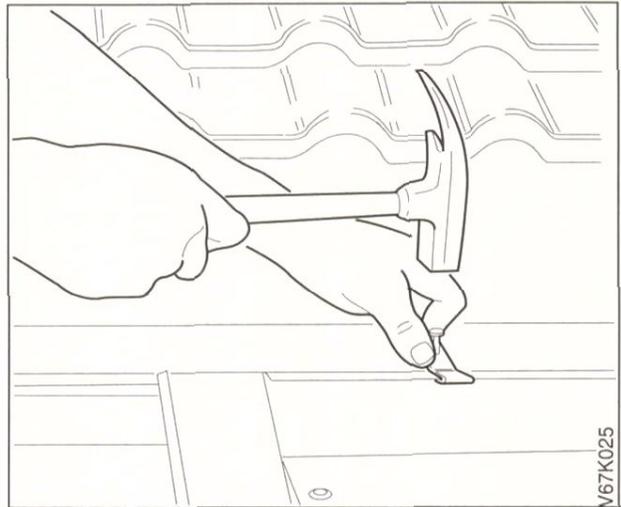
Obere Abschlußbleche am Rand zu den Ziegeln mit zwei Befestigungshaken pro Blech auf der Dachlatte fixieren.
